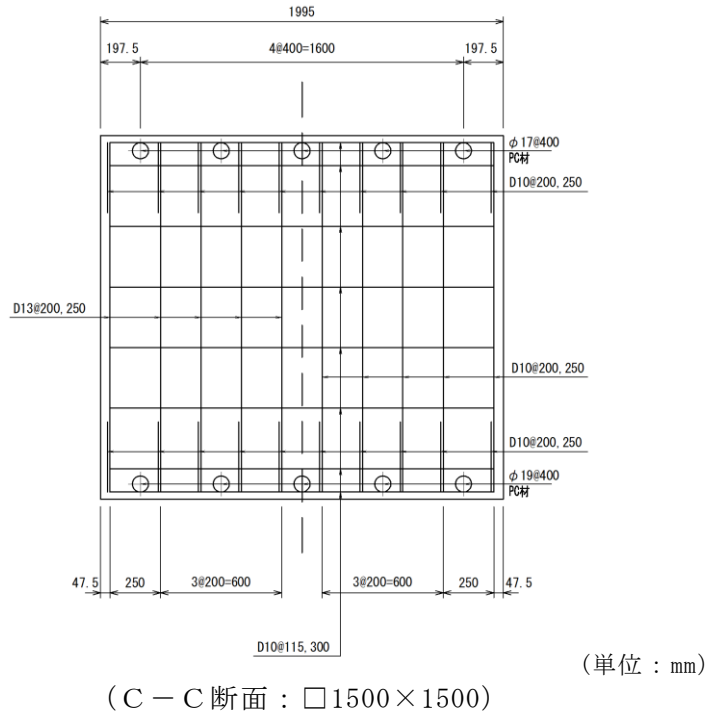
(3) 屋外排水路 (防波壁横断部) の概略配筋図
